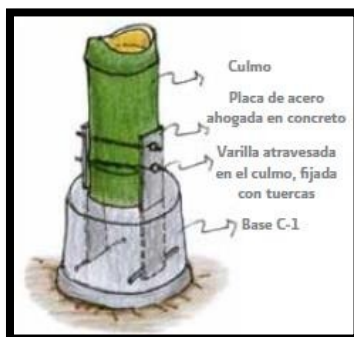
Ilustración 15.- Anclaje en columnas con elementos verticales incl. pasador y pernos y refuerzo de acero con soleras
